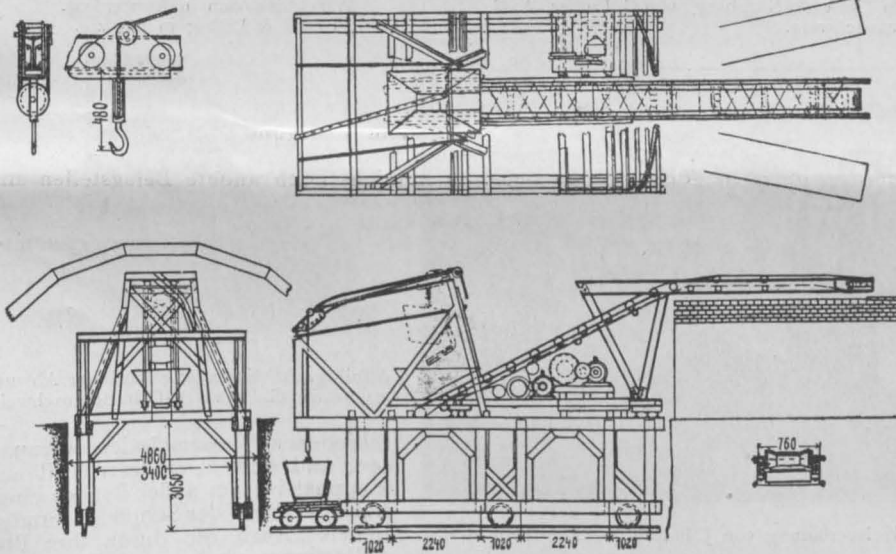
a — d. Tunnel-Gurtförderer für Beton in Washington.
